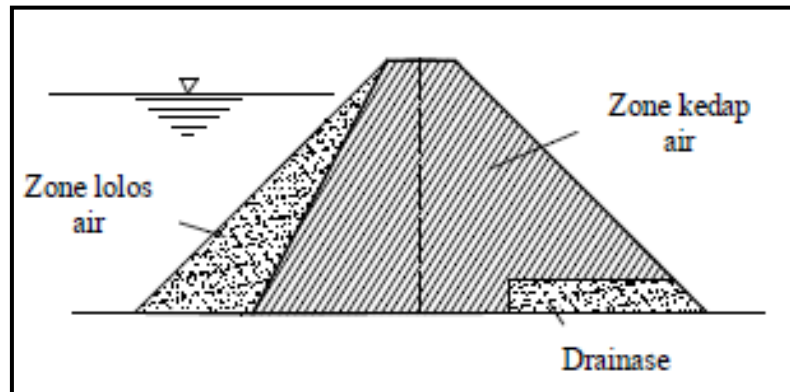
Tipe Embung Berdasarkan Jalannya Air
